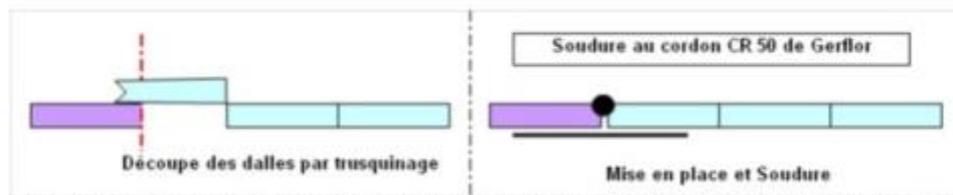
schéma de découpe par trusquinage et mise en place du cordon CR 50
